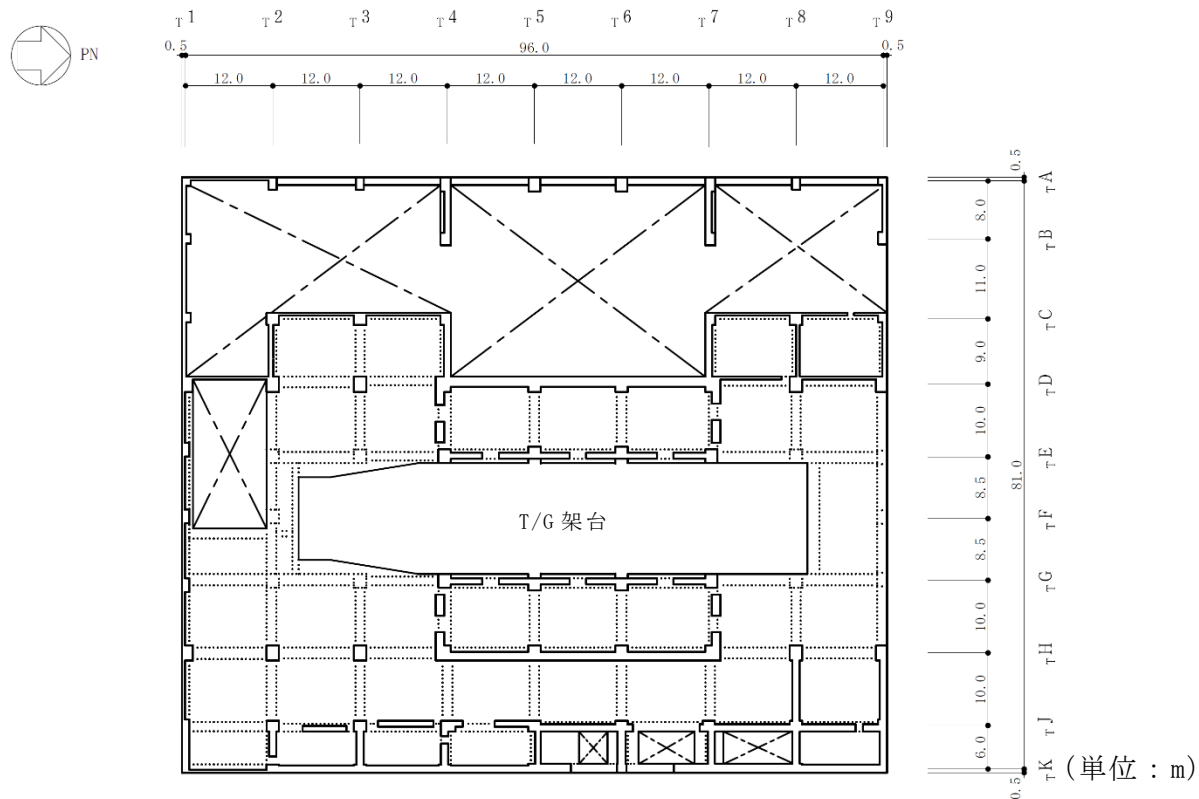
タービン建屋の概略平面図 (2F, T.M.S.L. 20.4m) (4/6)
